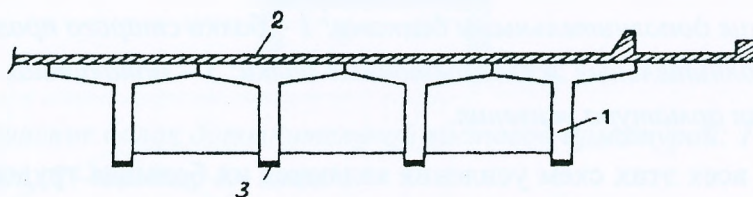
Усиление пролетных строений монолитной плитой: 1 – существующее пролетное строение; 2 – монолитная плита; 3 – дополнительная полосовая арматура.
